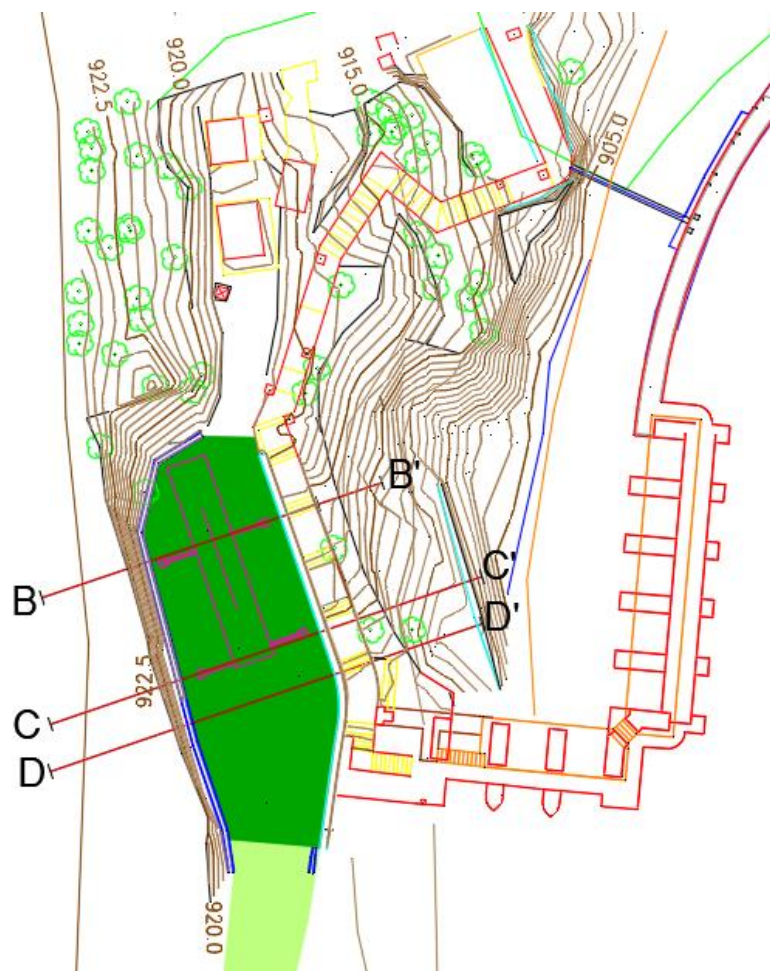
Planta de perfiles geológico-geotécnicos elaborados.
